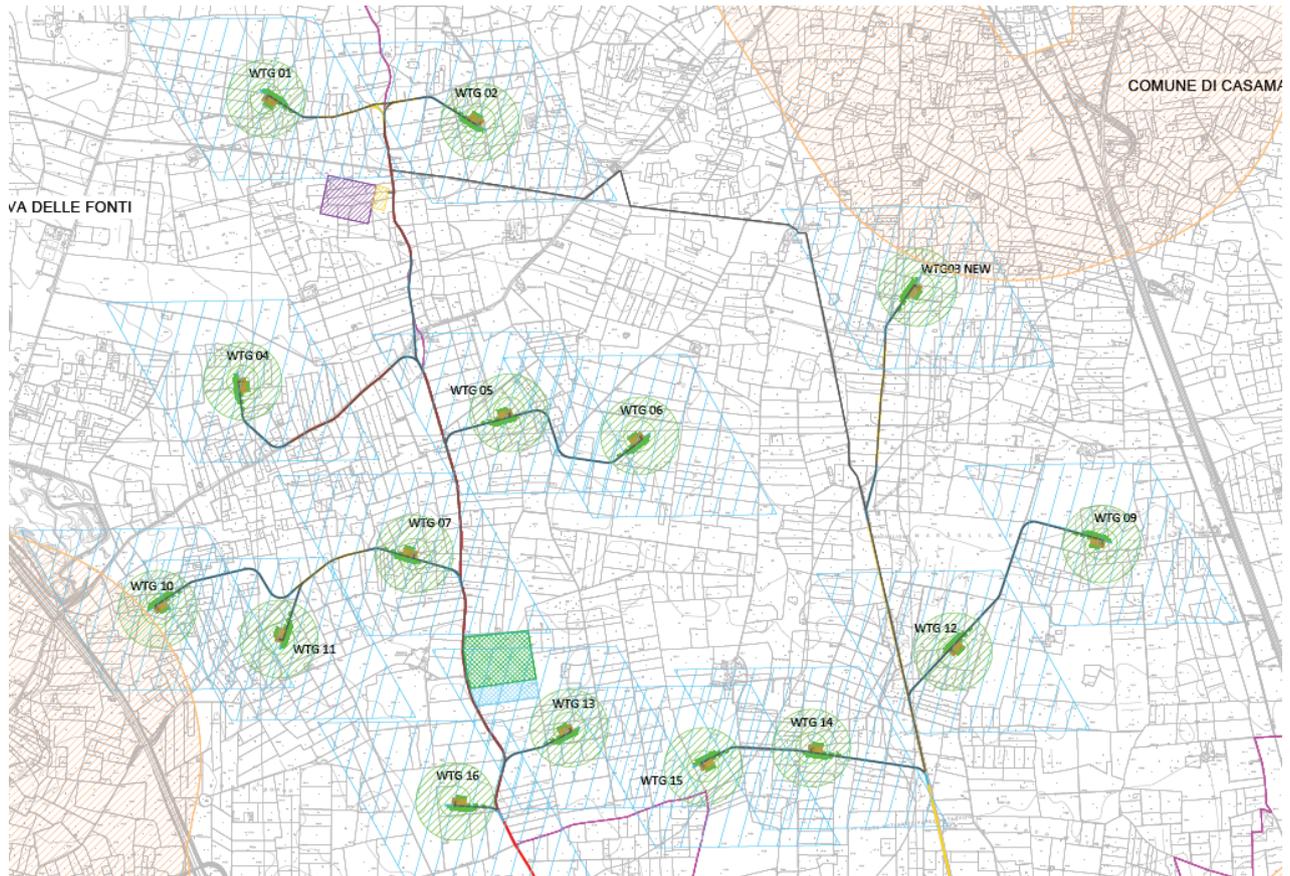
Individuazione su ortofoto dell'impianto in progetto
